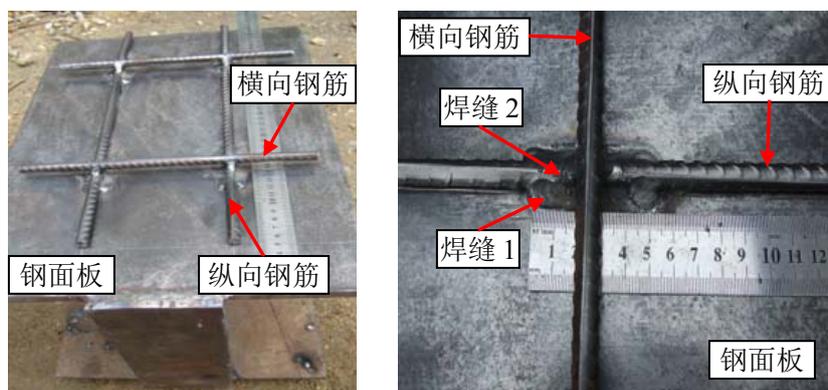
焊接水平钢筋网剪力连接件构造示意
